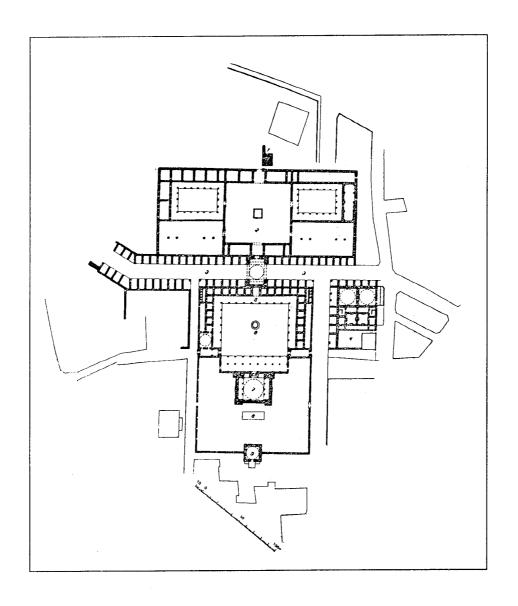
مسقط أفقي لمدرسة محمد باشا في فوتجا (عن :Pašić) .
